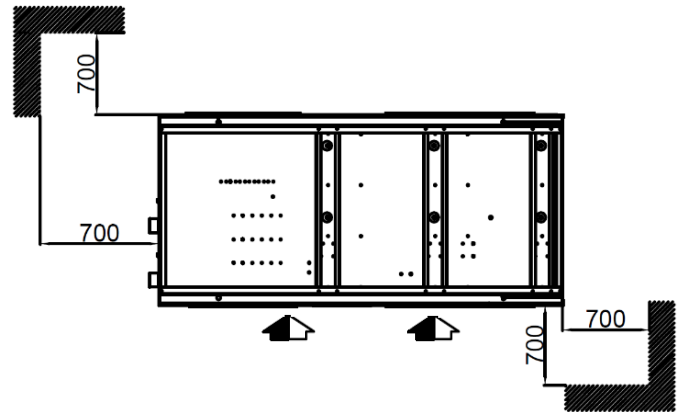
Mindestplatzbedarf [mm] für Plattform-1-Maschinen
